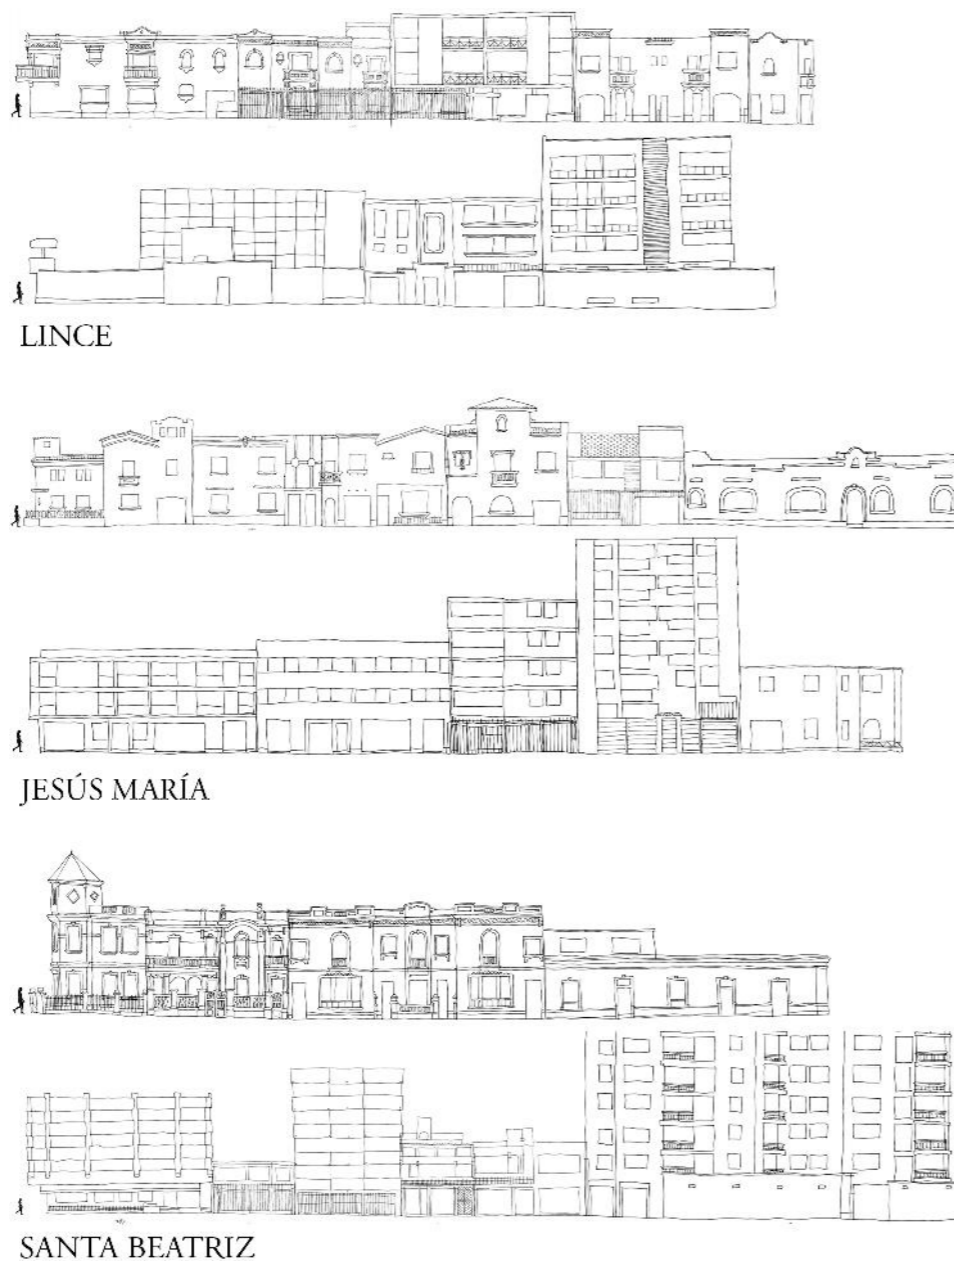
Levantamientos formales de las fachadas Tipo A y Tipo B.
